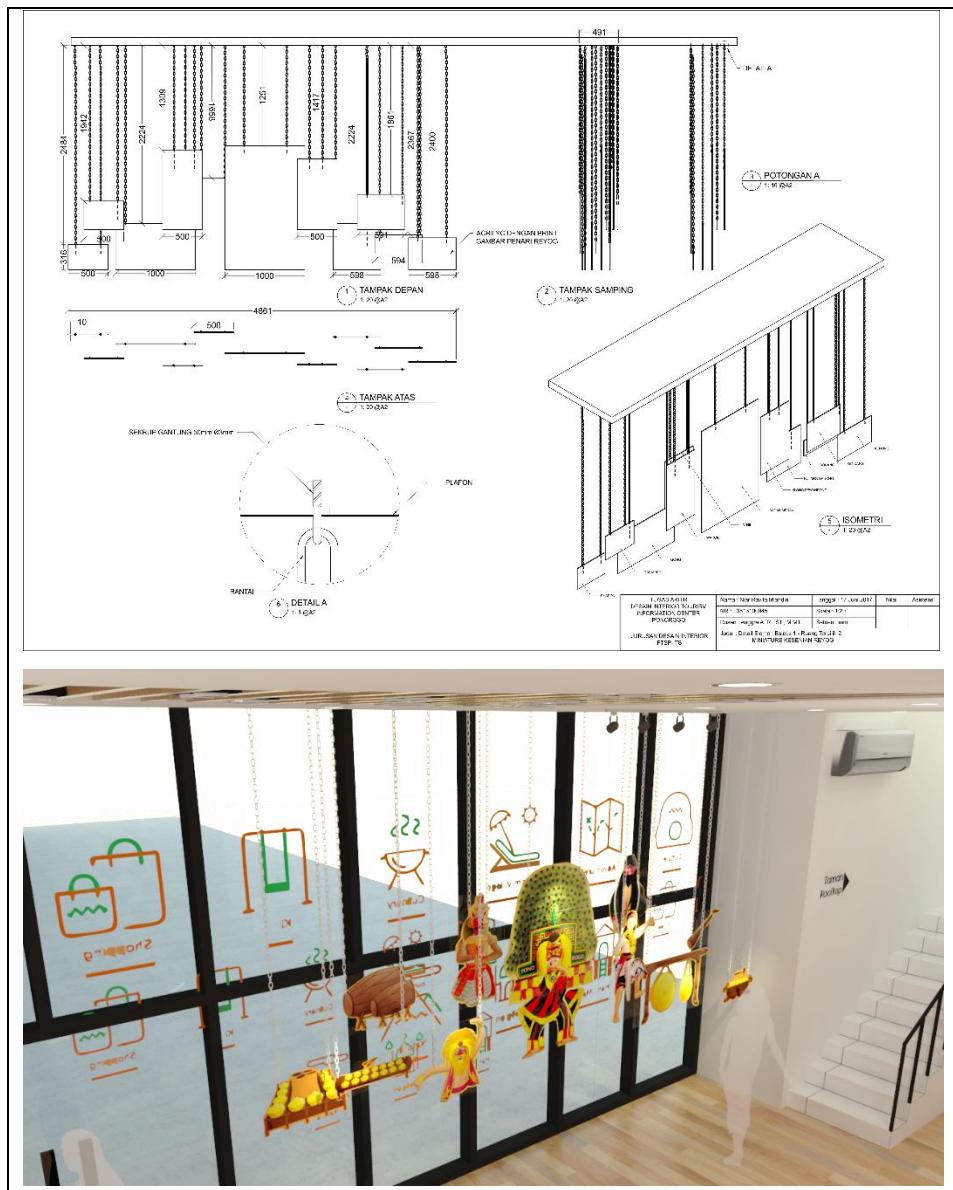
Detail Furniture 1 Ruang Terpilih 2
